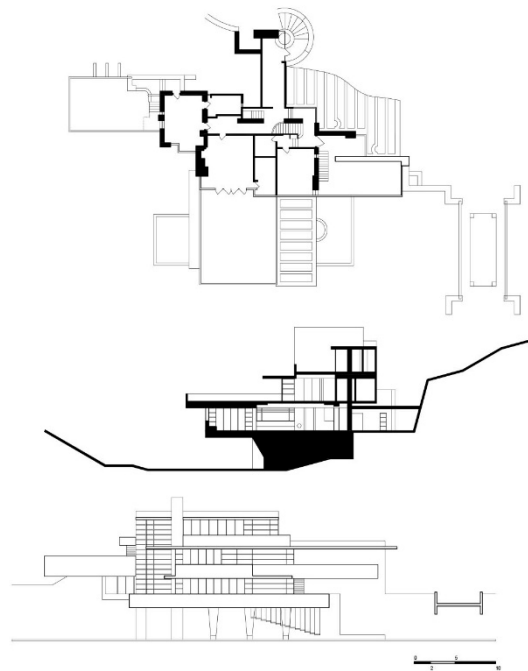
Redesenho da planta, corte e elevação – Casa da Cascata
